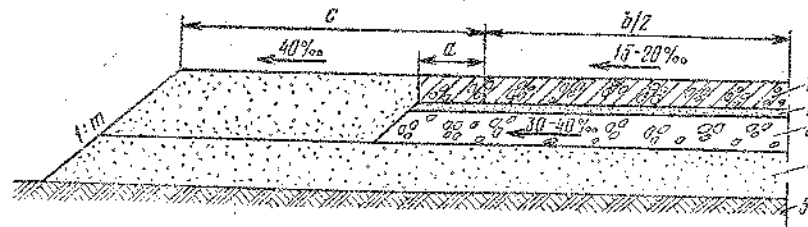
Поперечный профиль жесткой дорожной одежды с монолитным цементобетонным покрытием:
